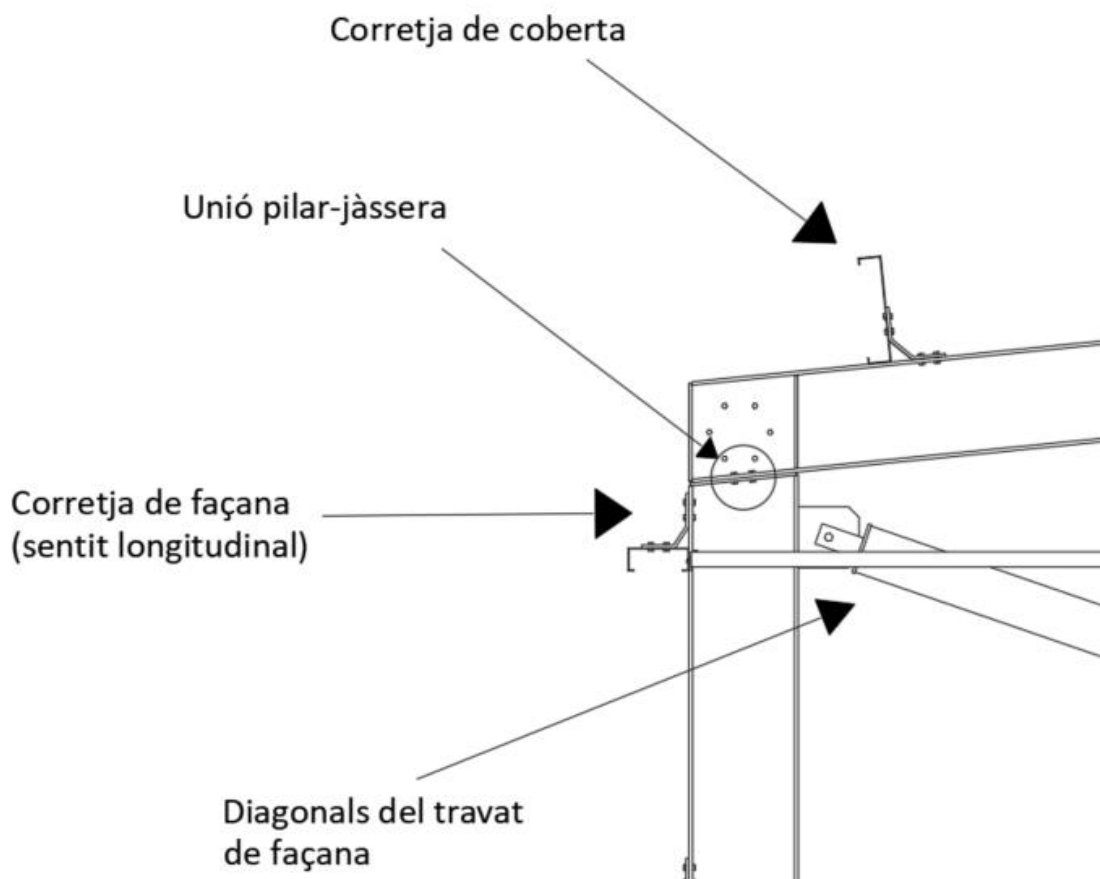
Detall de la unió entre el pilar tester IPE 360 i la jàssera (Font: Tekla Structures)
